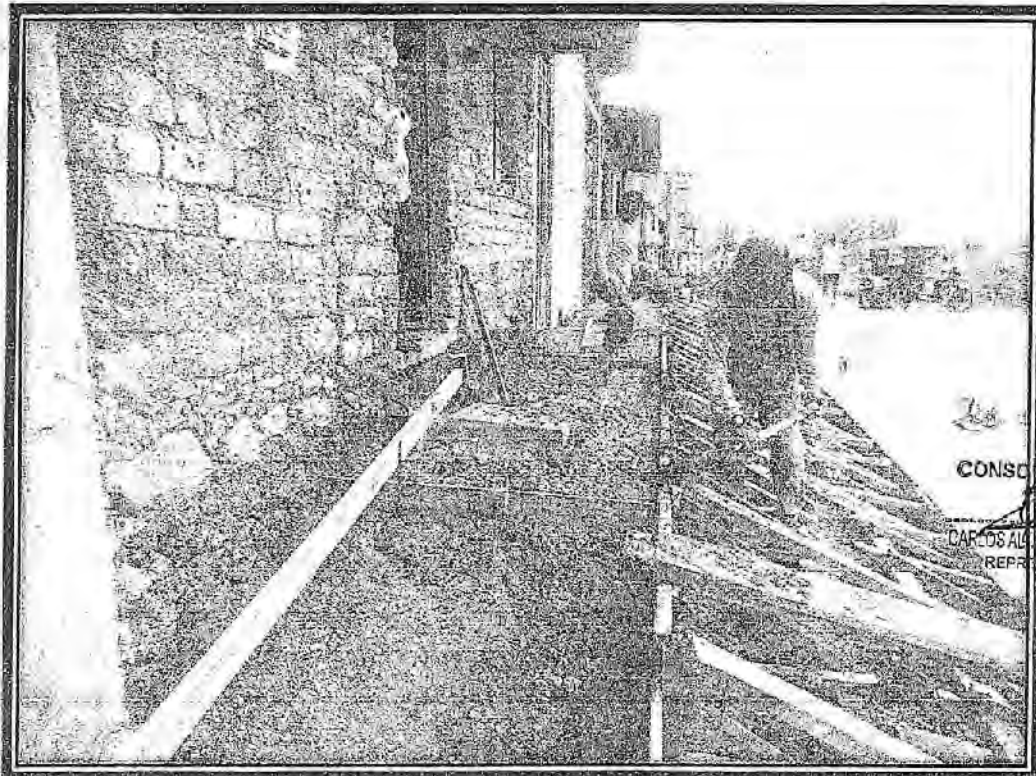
06/11/19 habilitando zona de vaciado para pavimento de concreto f'c=210 en el Psj. Linares Cdra 02.
